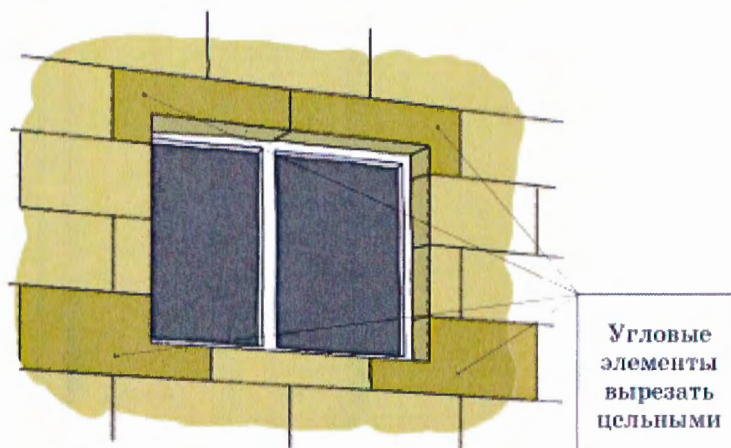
Схема расположения теплоизоляционных плит в углах оконных проемов
